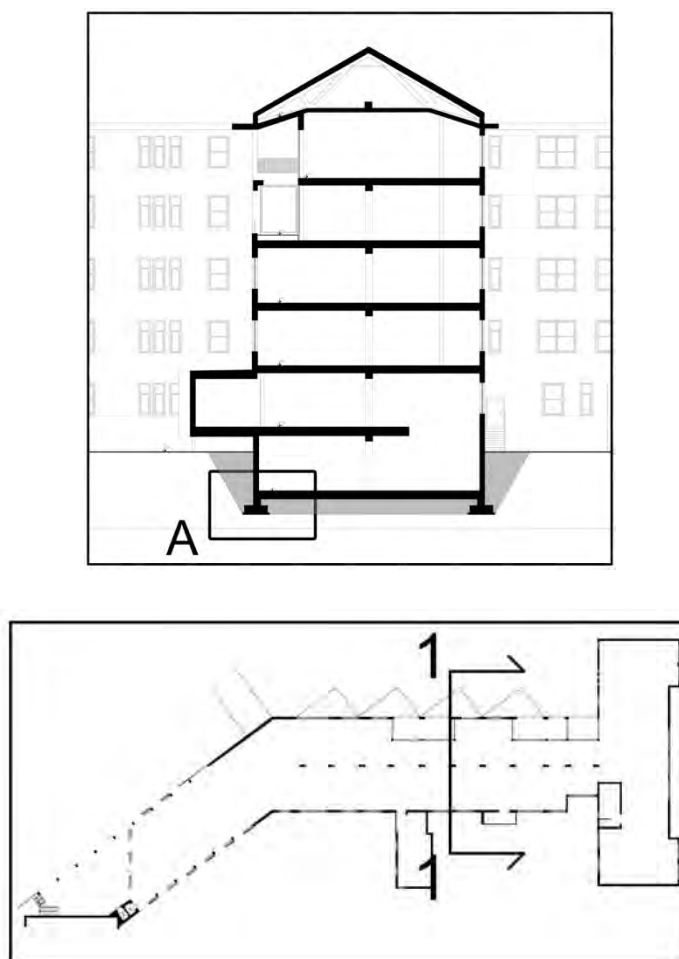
Riferimenti del nodo 1-A in pianta e sezione
